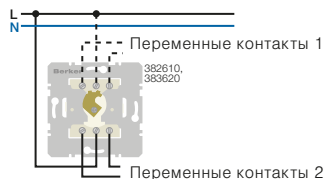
Выключатель/переключатель 1- и 2-полюсный для профильных полуцилиндров [№ для заказа 3826 10, 3836 20]
